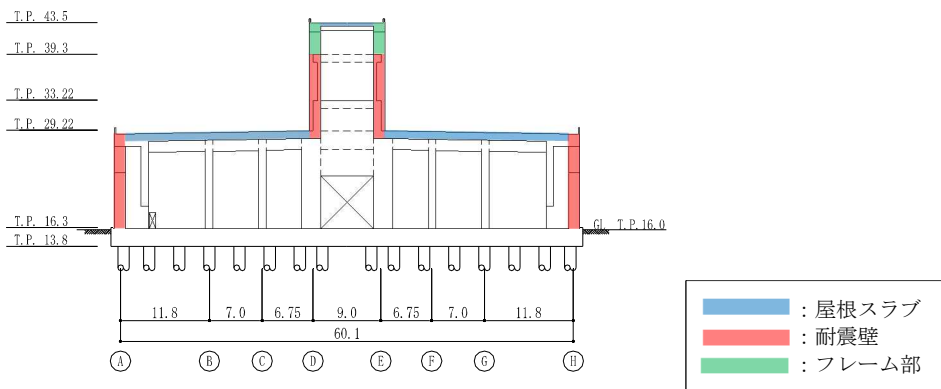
B-B 断面図 (EW 方向) (単位 : m)
